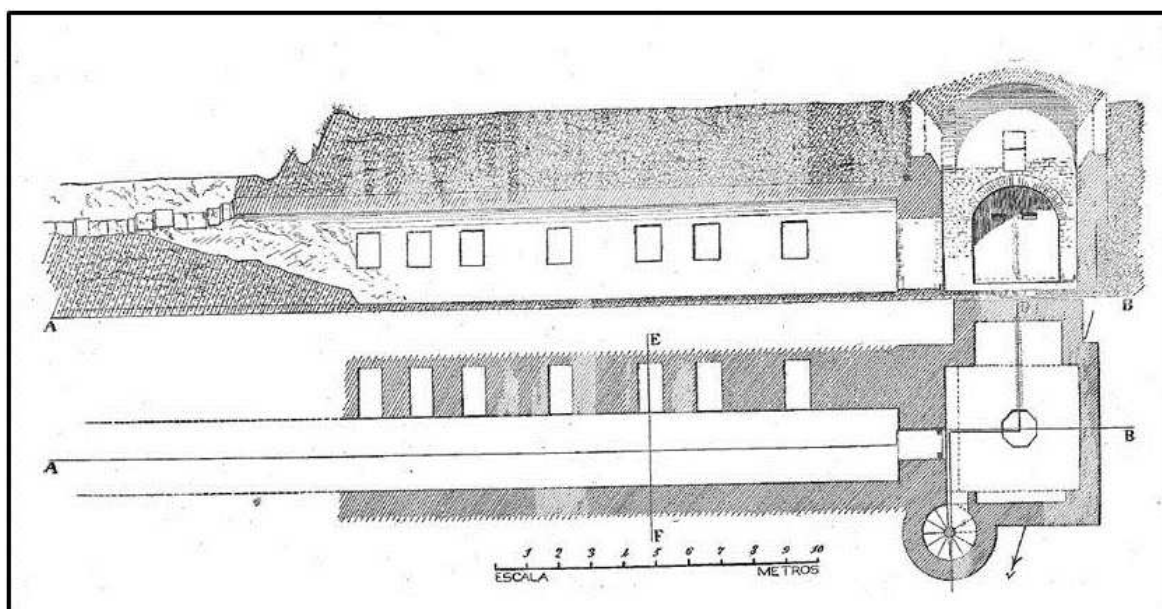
Detalle del criptopórtico, alzado y planta realizados por Juan Cabré (1923).
